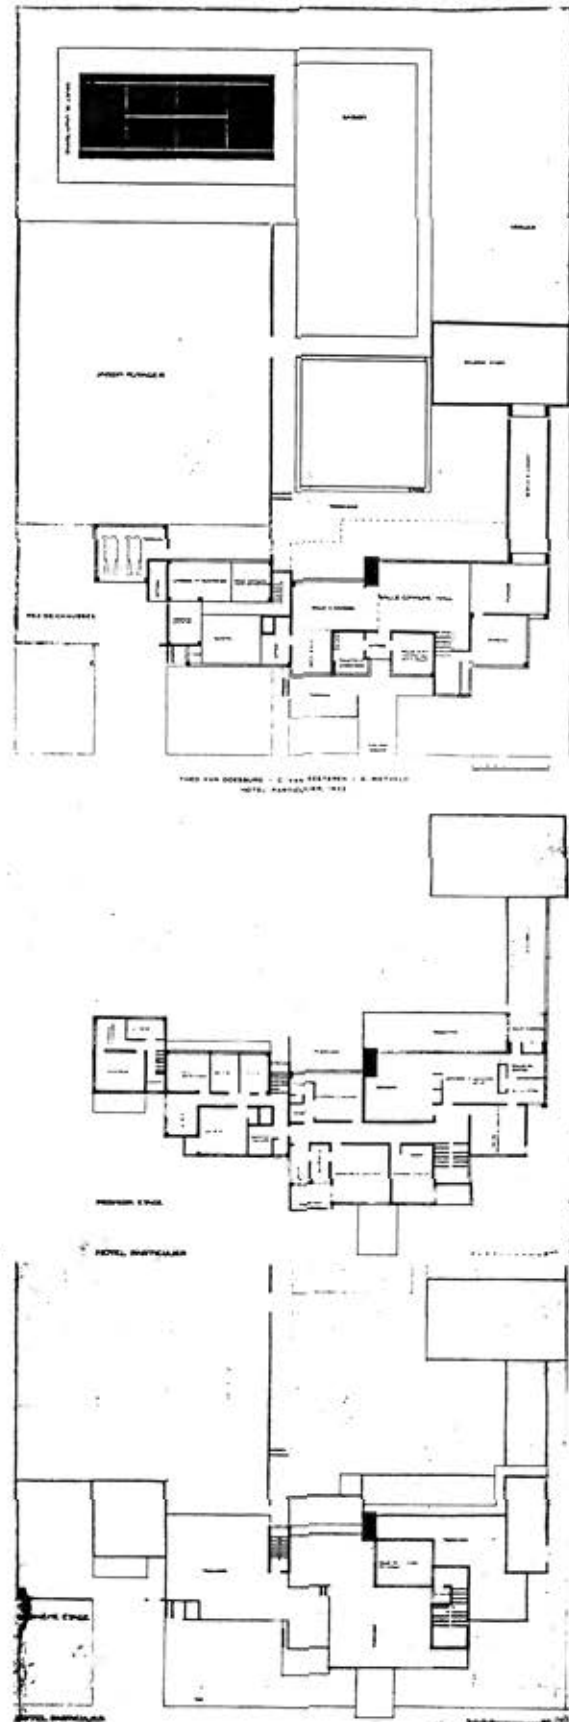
Plantas baja, primera y de cubierta. Hotel particular. Escala aproximada 1 :1000
